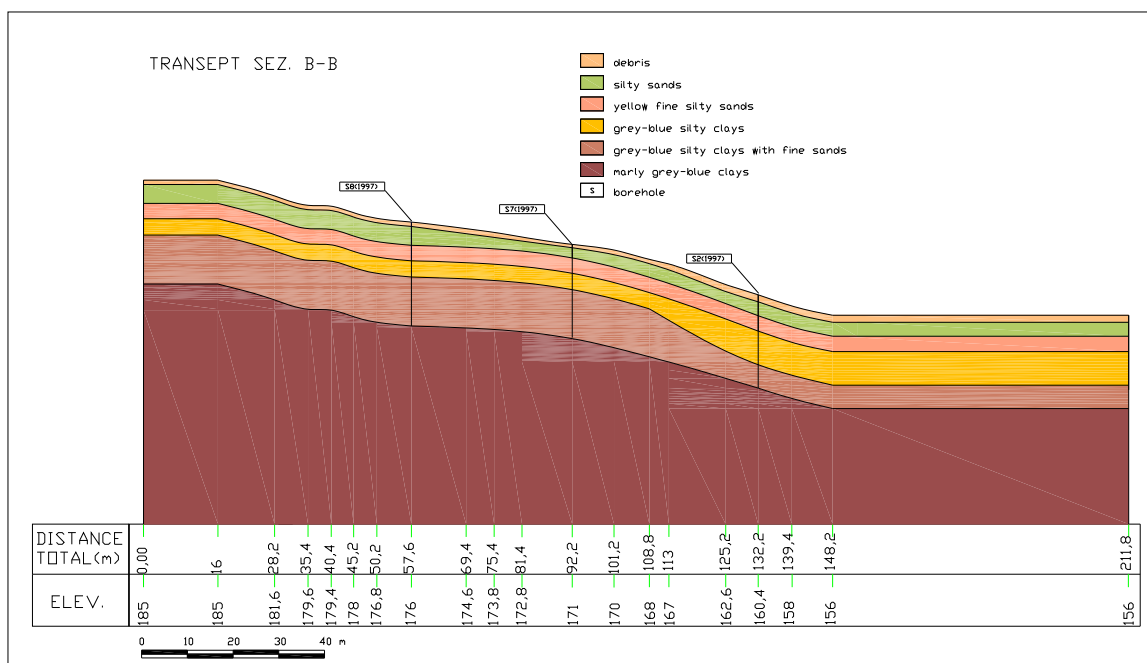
Sezione B-B della collina di Monte Po, con la localizzazione dei sondaggi S2, S7 ed S8.
